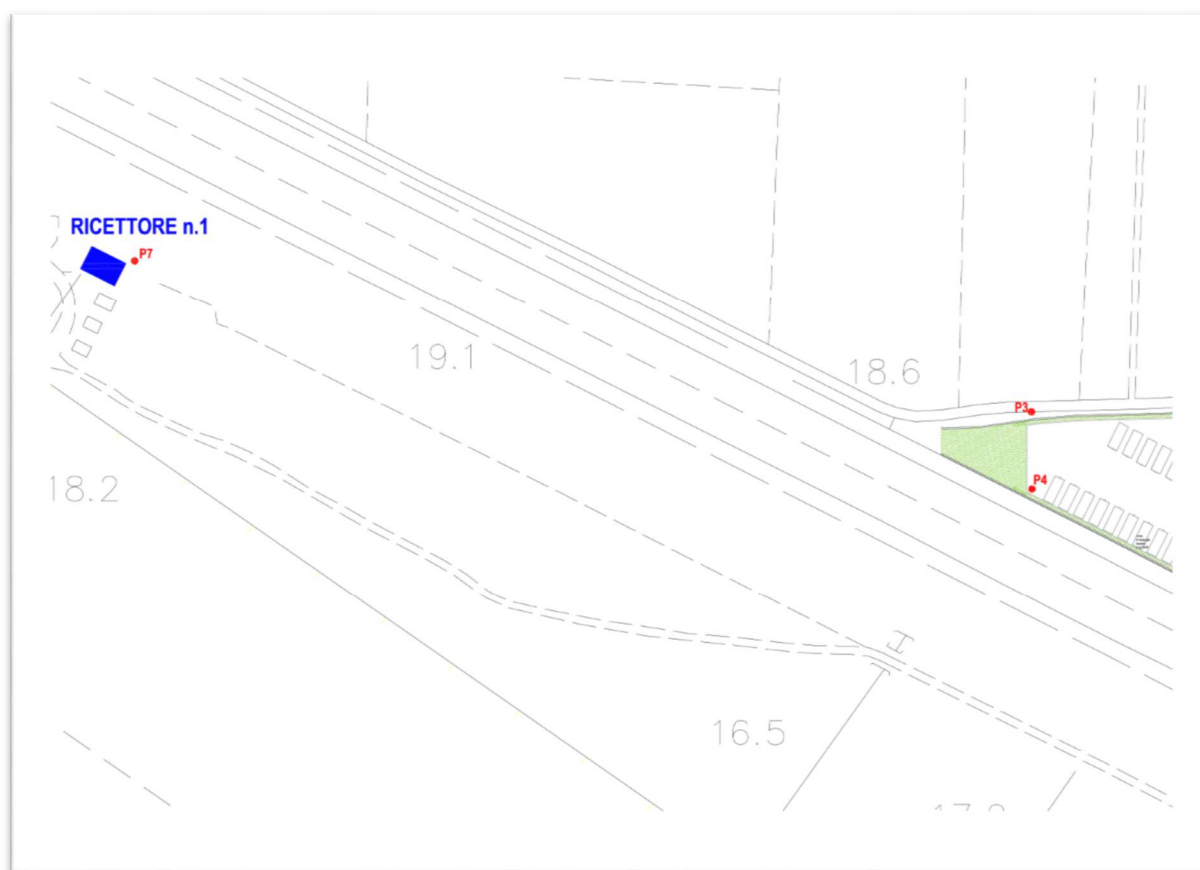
Stralcio planimetrico con individuazione del ricettore n.1
